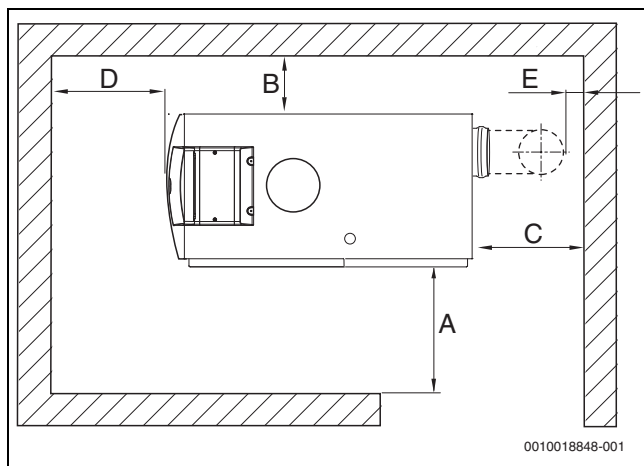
Wandabstände im Aufstellraum (Rechts-Ausführung)
